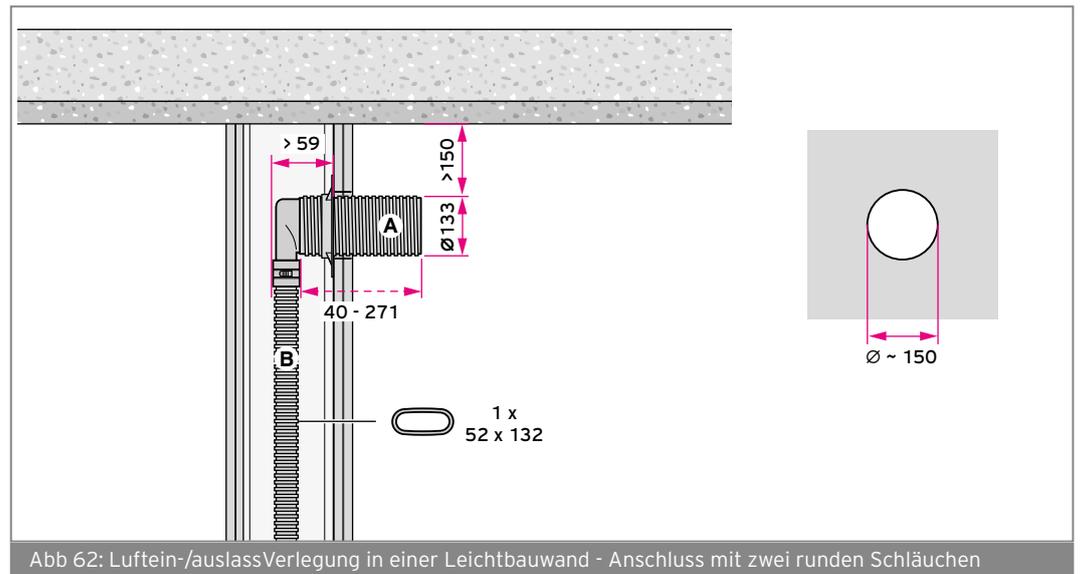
Luftein-/auslassVerlegung in einer Leichtbauwand - Anschluss mit zwei runden Schläuchen
